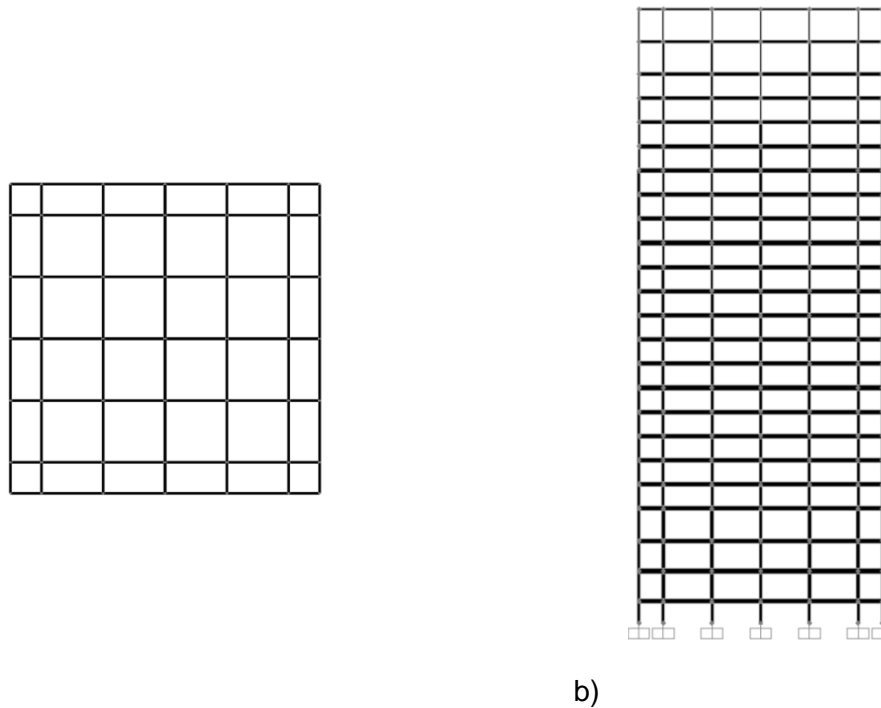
Predimensionado basado en rigidez de vigas y columnas.
